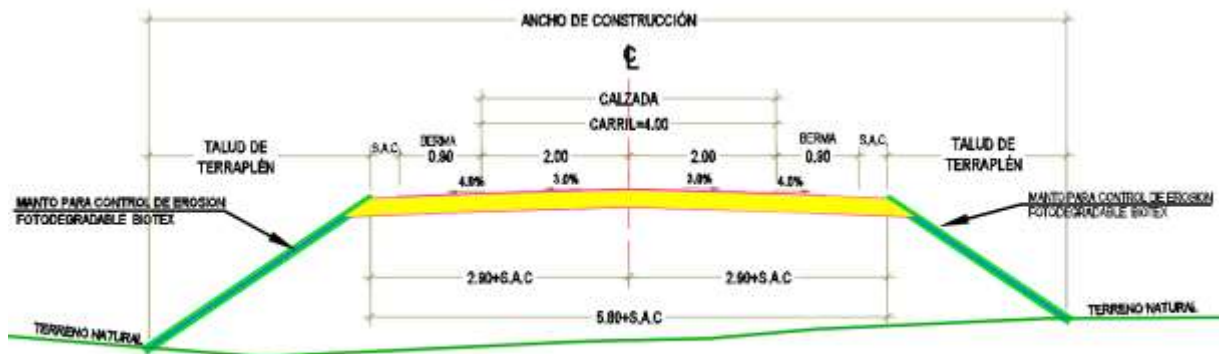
Sección típica en relleno con protección de talud. Fuente: Plano de secciones típicas.
